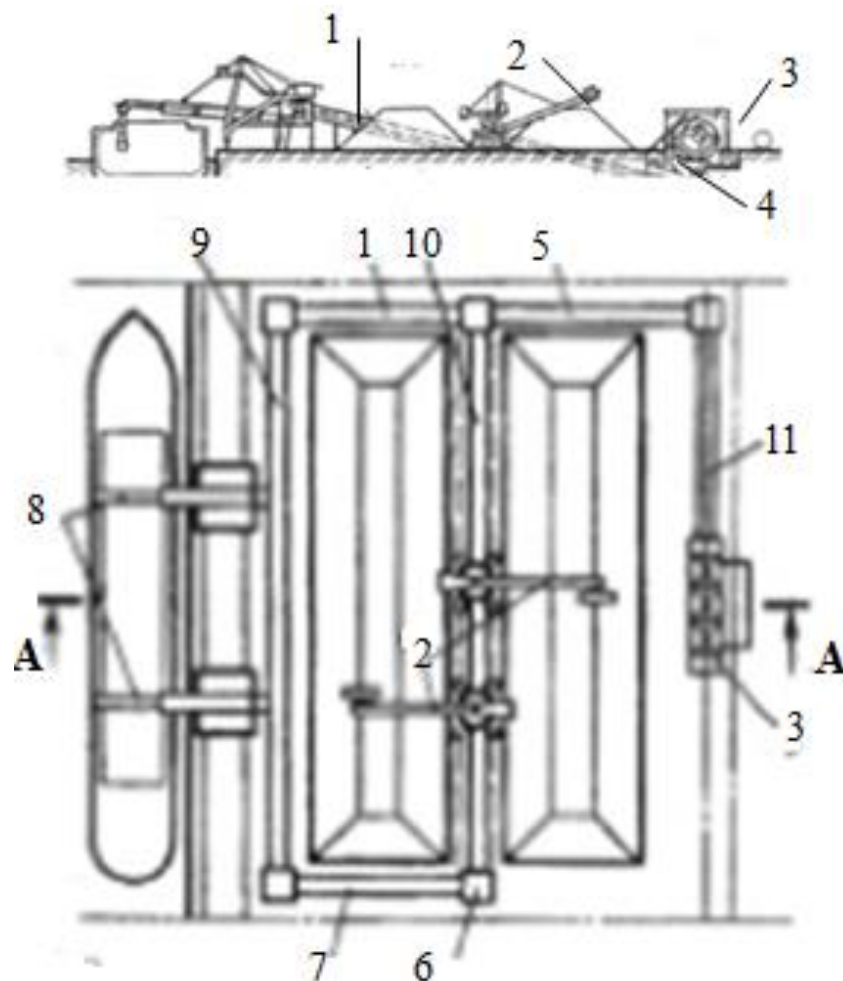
Специализированный перегрузочный комплекс с приёмом угля из железнодорожных вагонов через роторный вагоноопрокидыватель: 1, 5, 7, 9, 11 – ленточные конвейеры, 2 - стакеры и реклаймеры, 3 – вагоноопрокидыватель, 4 – приемный бункер, 6 – дробилка и очистка, 8 - судопогрузочные машины
